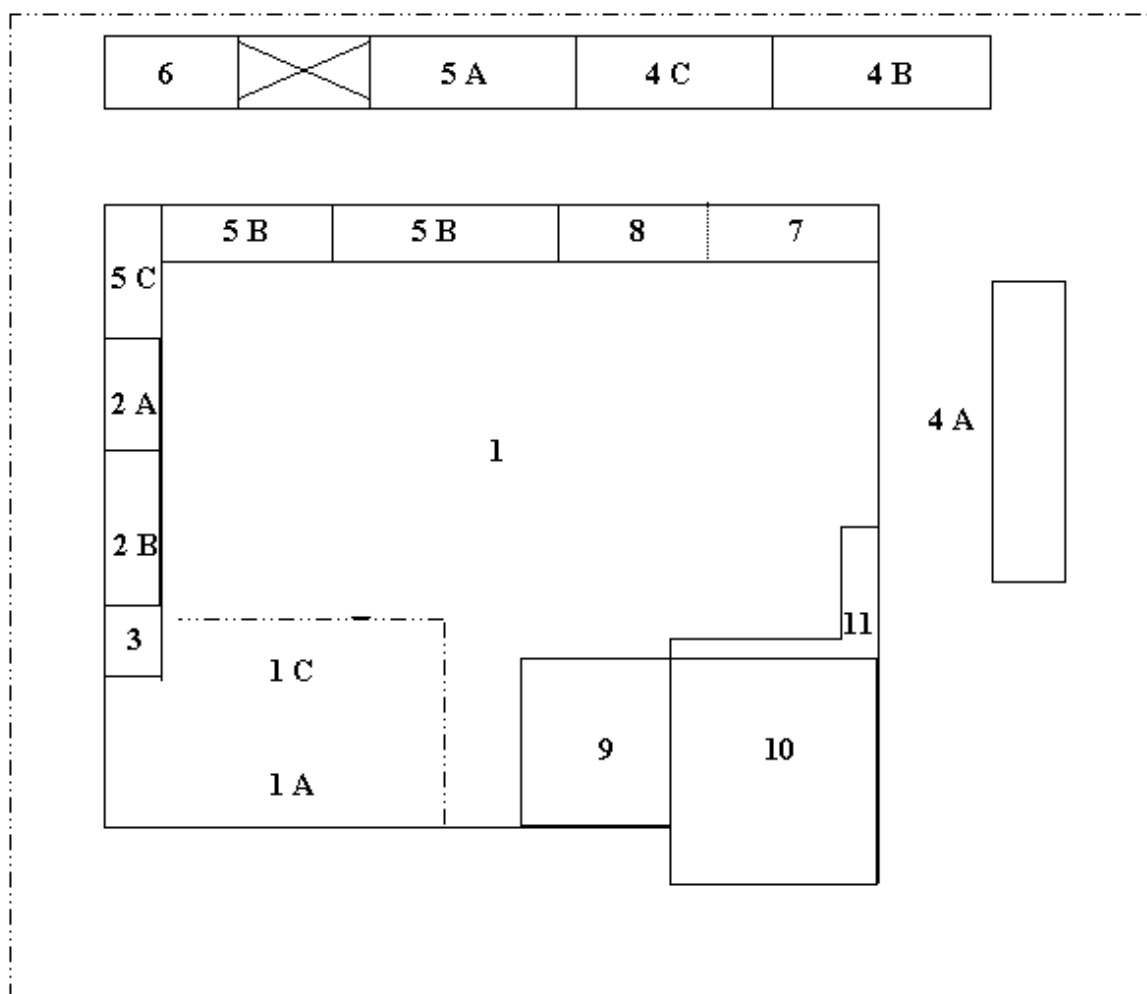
Haltungs- und Funktionsbereiche des Untersuchungsbetriebes, Grundriss-Skizze
